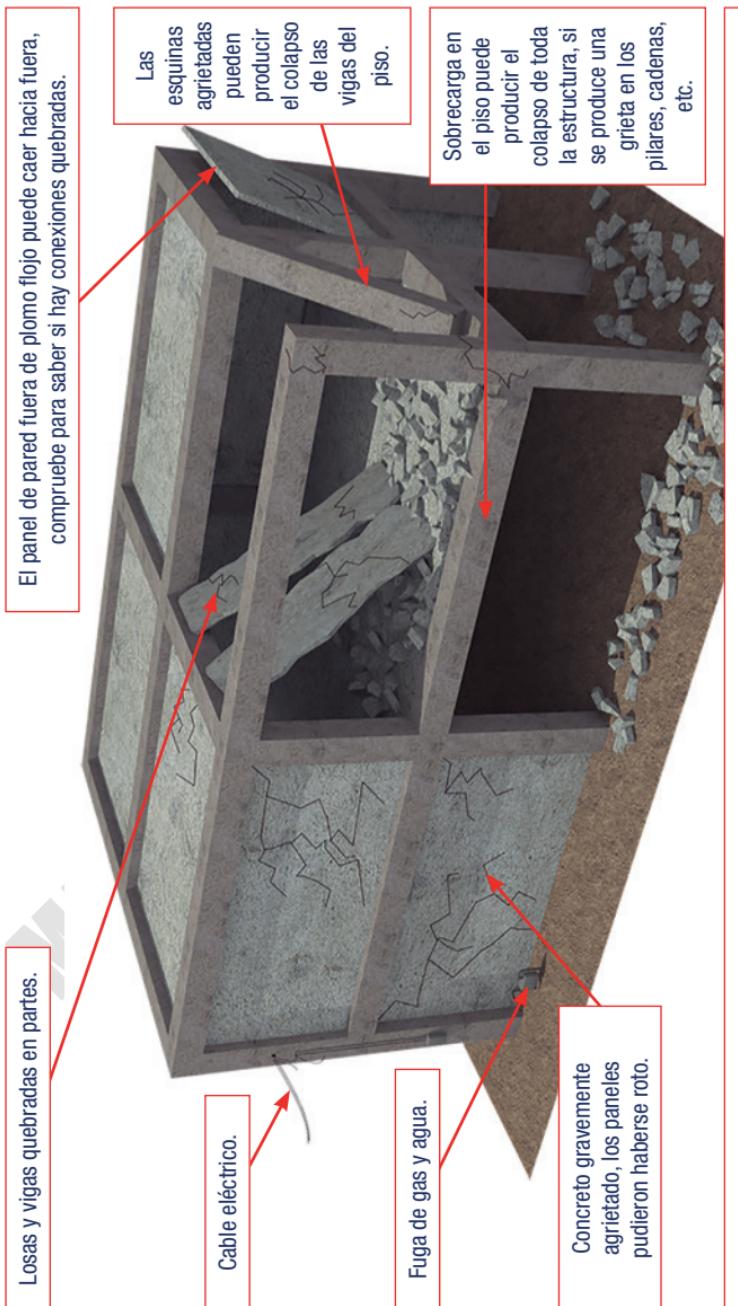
Peligros al evaluar construcciones de hormigón armado (concreto reforzado).
